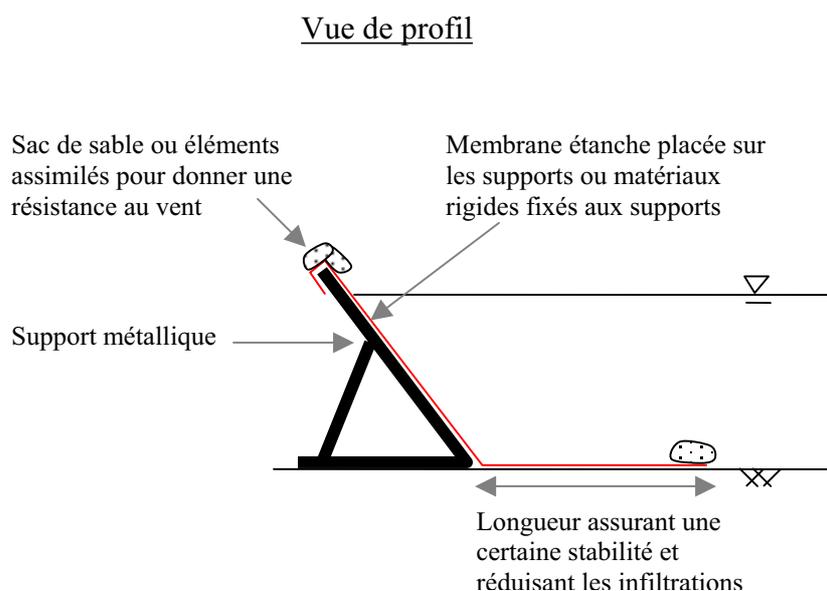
Schématisation (coupe en travers) d'un batardeau composé d'une structure servant de support et dont l'étanchéité est réalisée par un matériau de couverture
